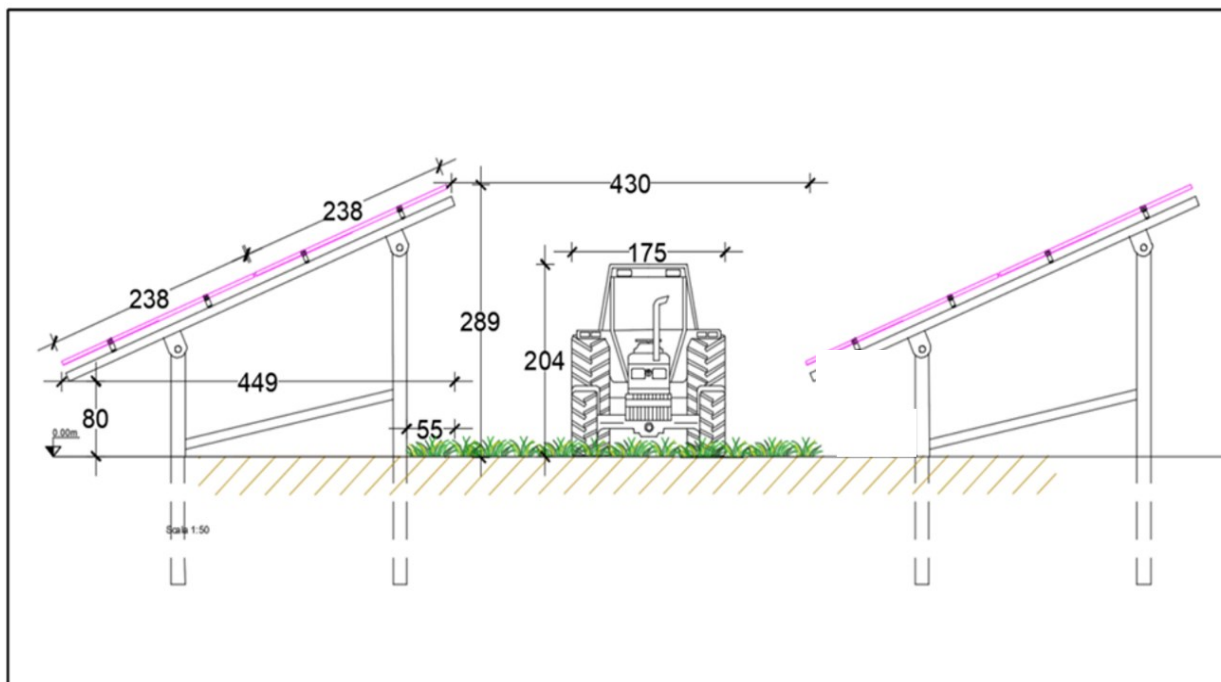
Particolare Strutture fisse con pali infissi nel terreno
